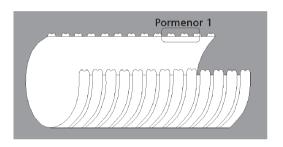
Perfil do tubo corrugado 2DREN de parede simples – tipo C1
